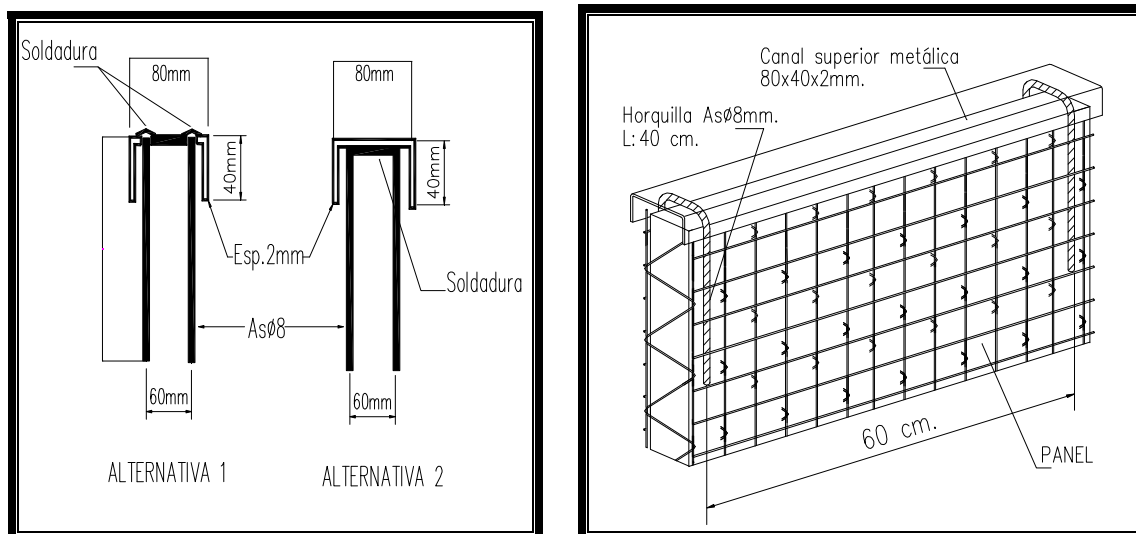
Accesorio para soporte de techumbre a base de armaduras de madera
